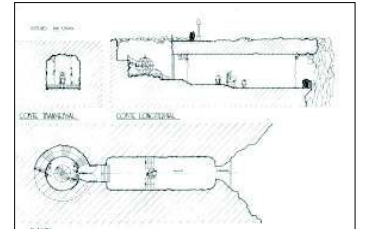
/XXI- Idem, 1991, Planta e Corte. Fonte: José Aurélio.
